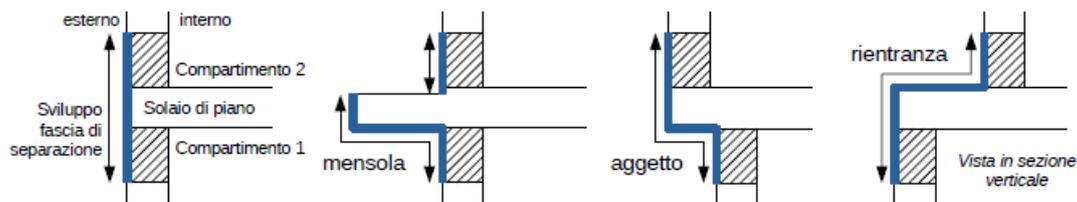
Fascia di separazione orizzontale, sezione verticale
